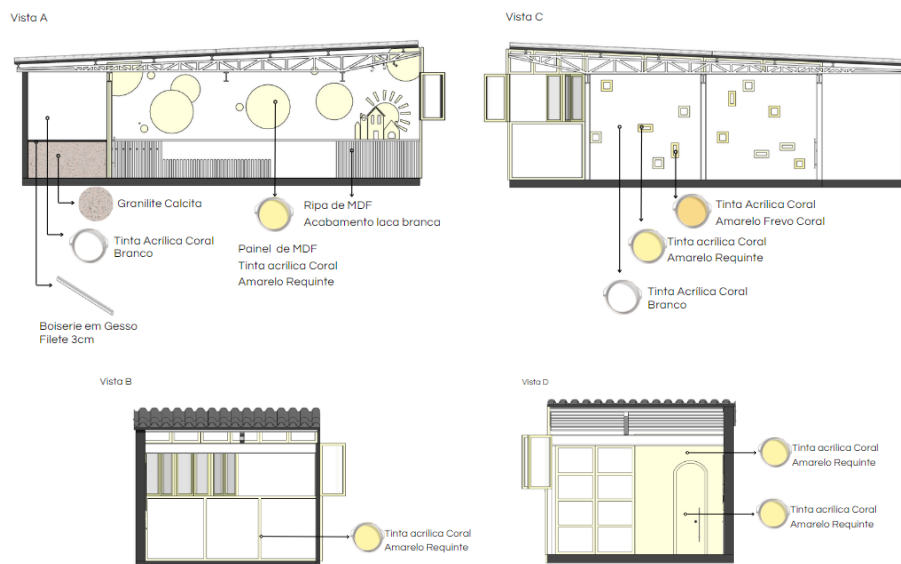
Sala Pôr do Sol: Planta Baixa dos Acabamentos
